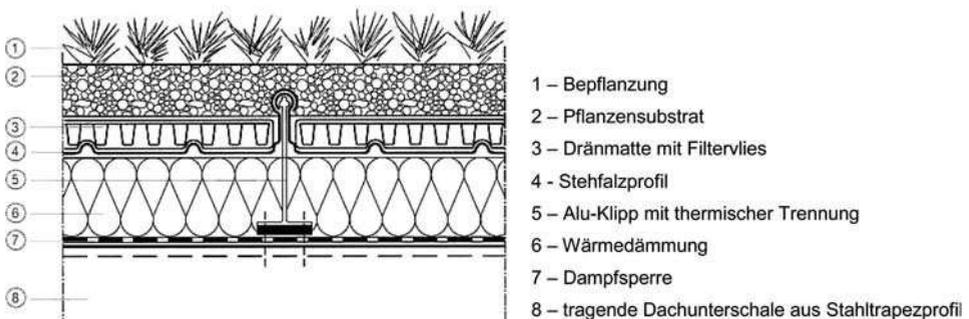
Schichtenaufbau für eine Dachbegrünung auf einer Deckung aus Aluminium-Stehfalzelementen
